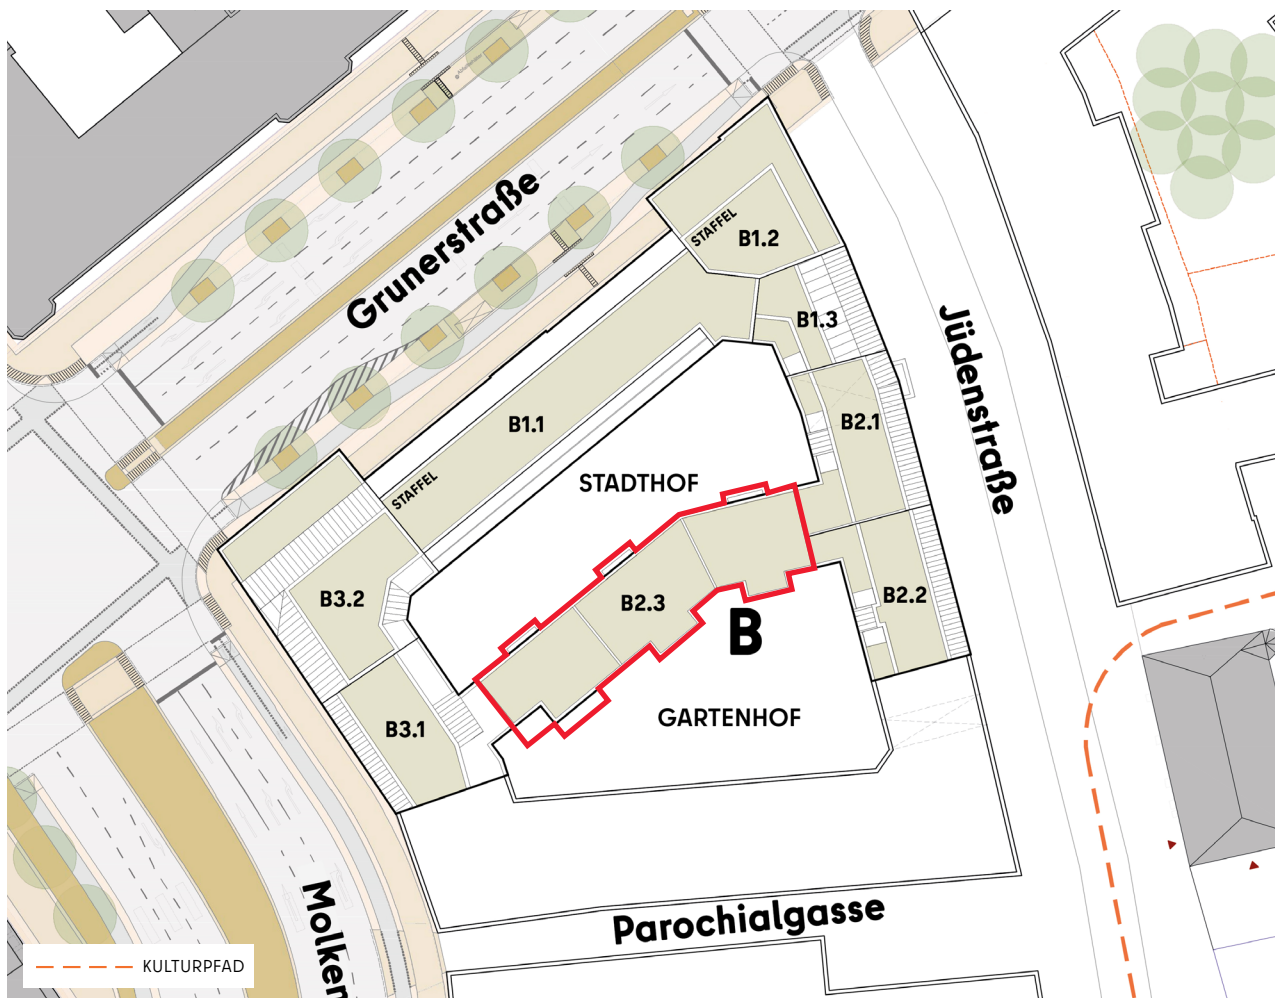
Dachaufsicht Block B mit Lage Haus B2.3
